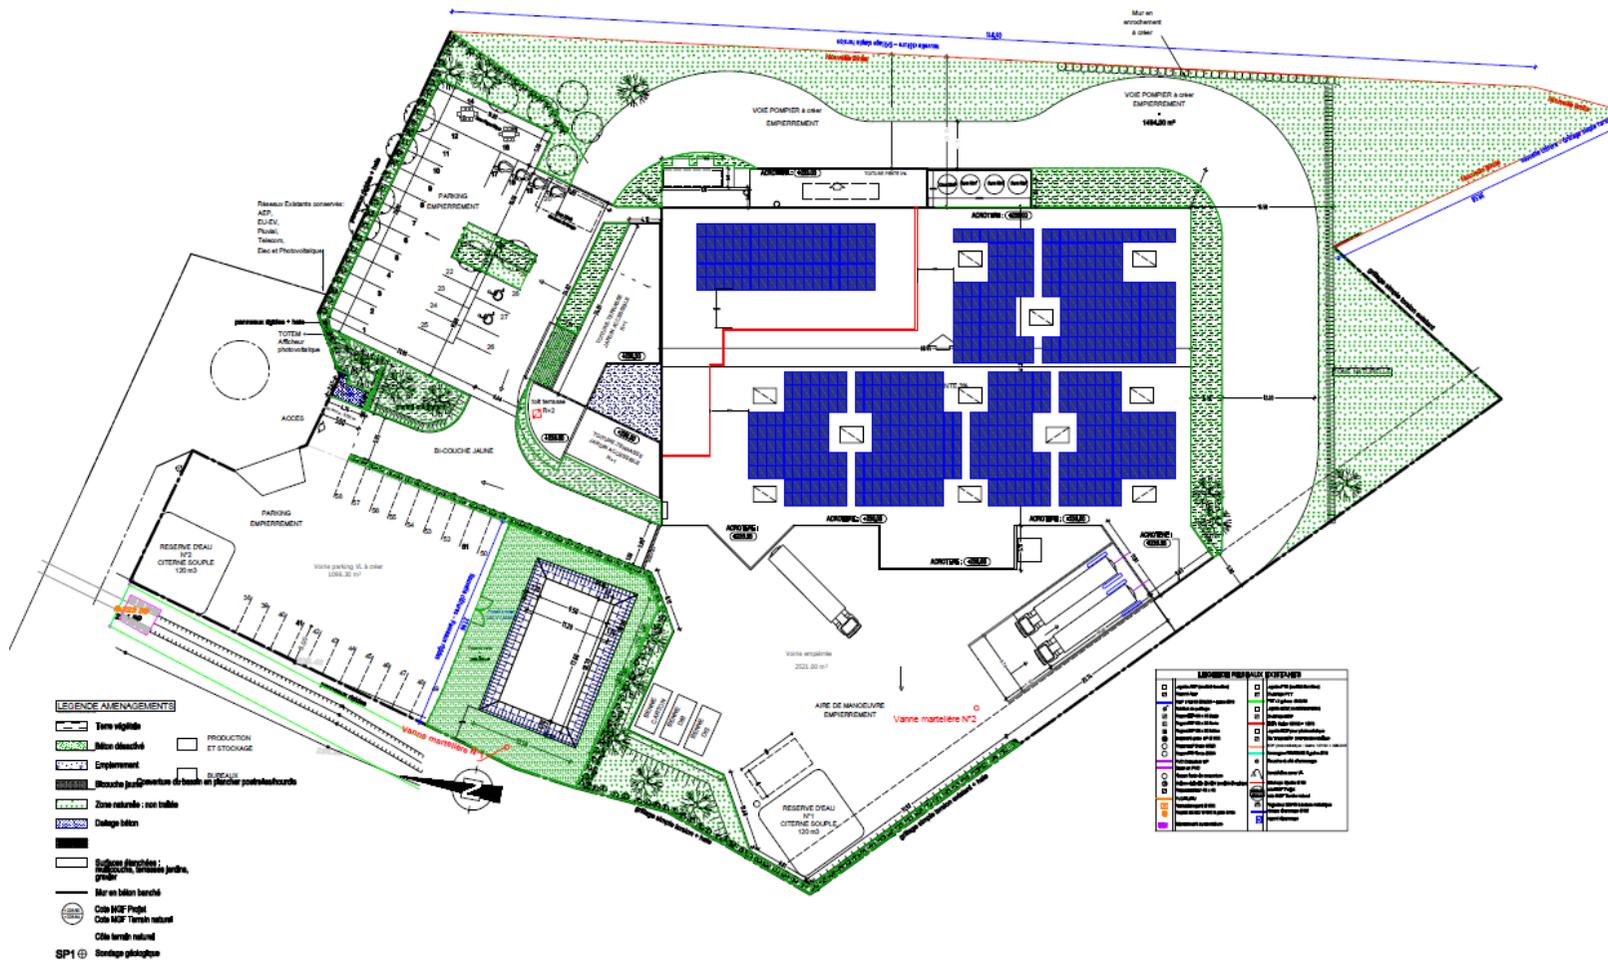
Plan de masse 1/200 - source : Cabinet AITEC
